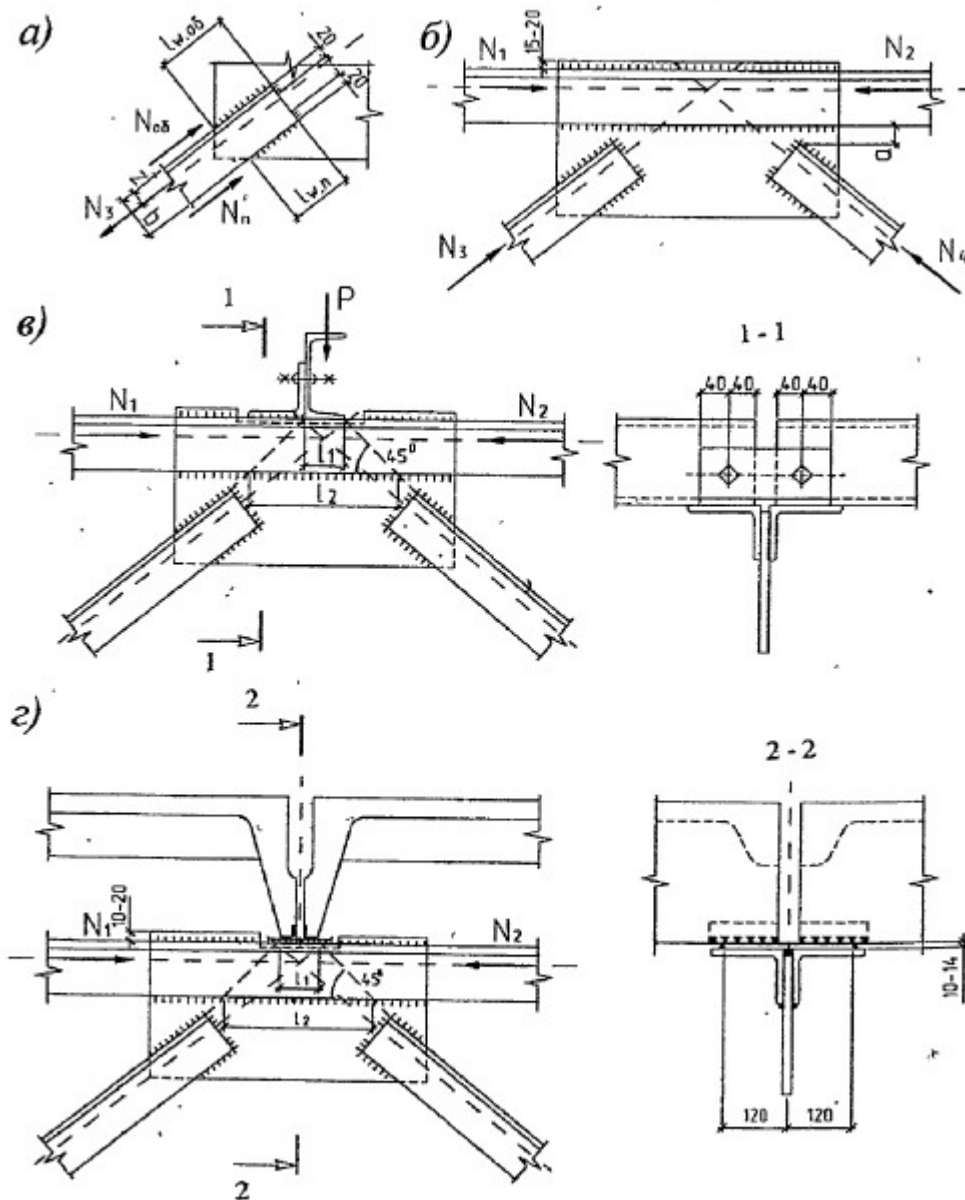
Узлы ферм из парных уголков: а – крепление раскоса к фасонке; б – промежуточный узел; в, г – опирание прогонов и плит
